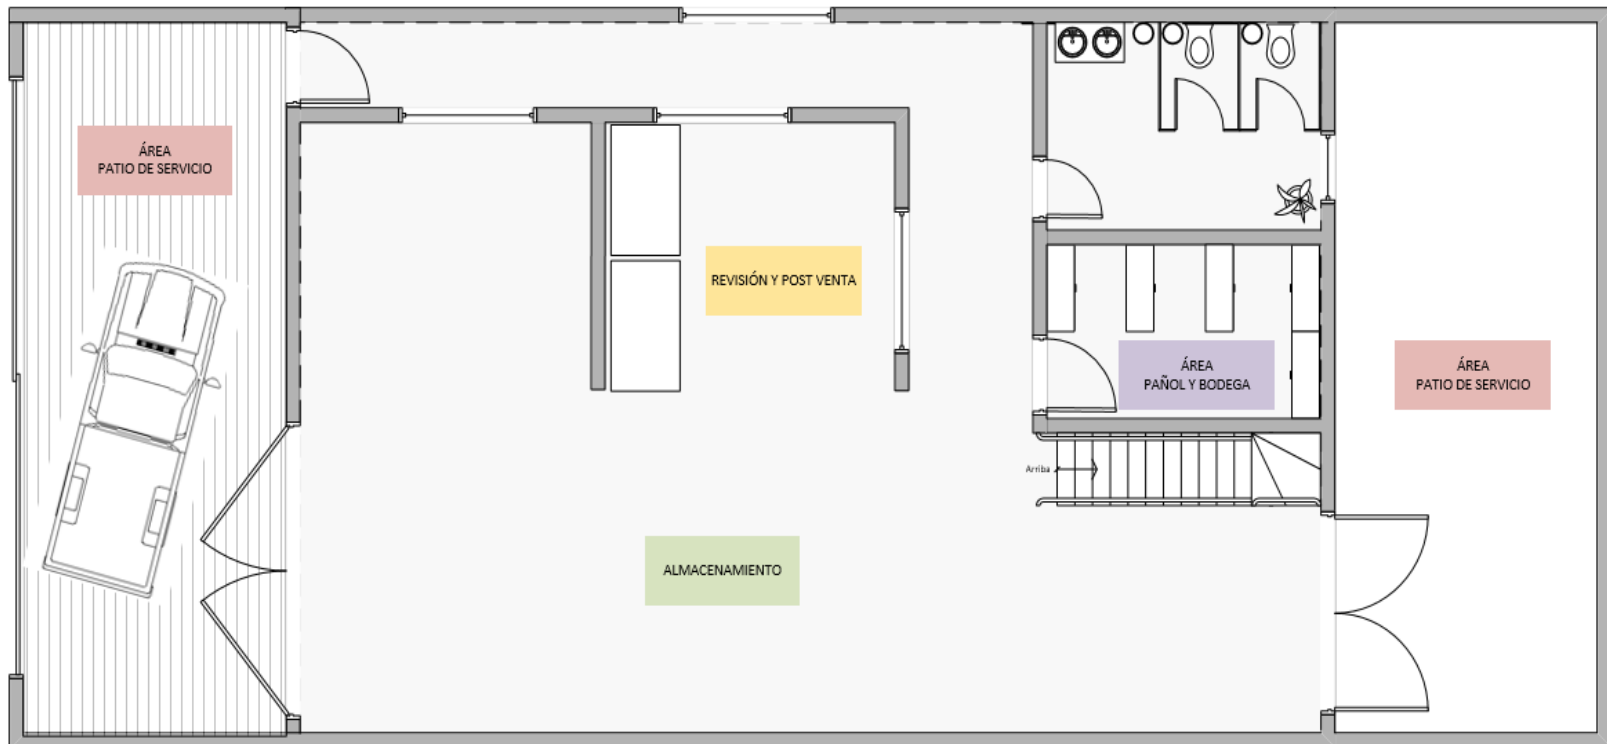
Lay Out de las Bodegas y Oficinas - Planta 1
